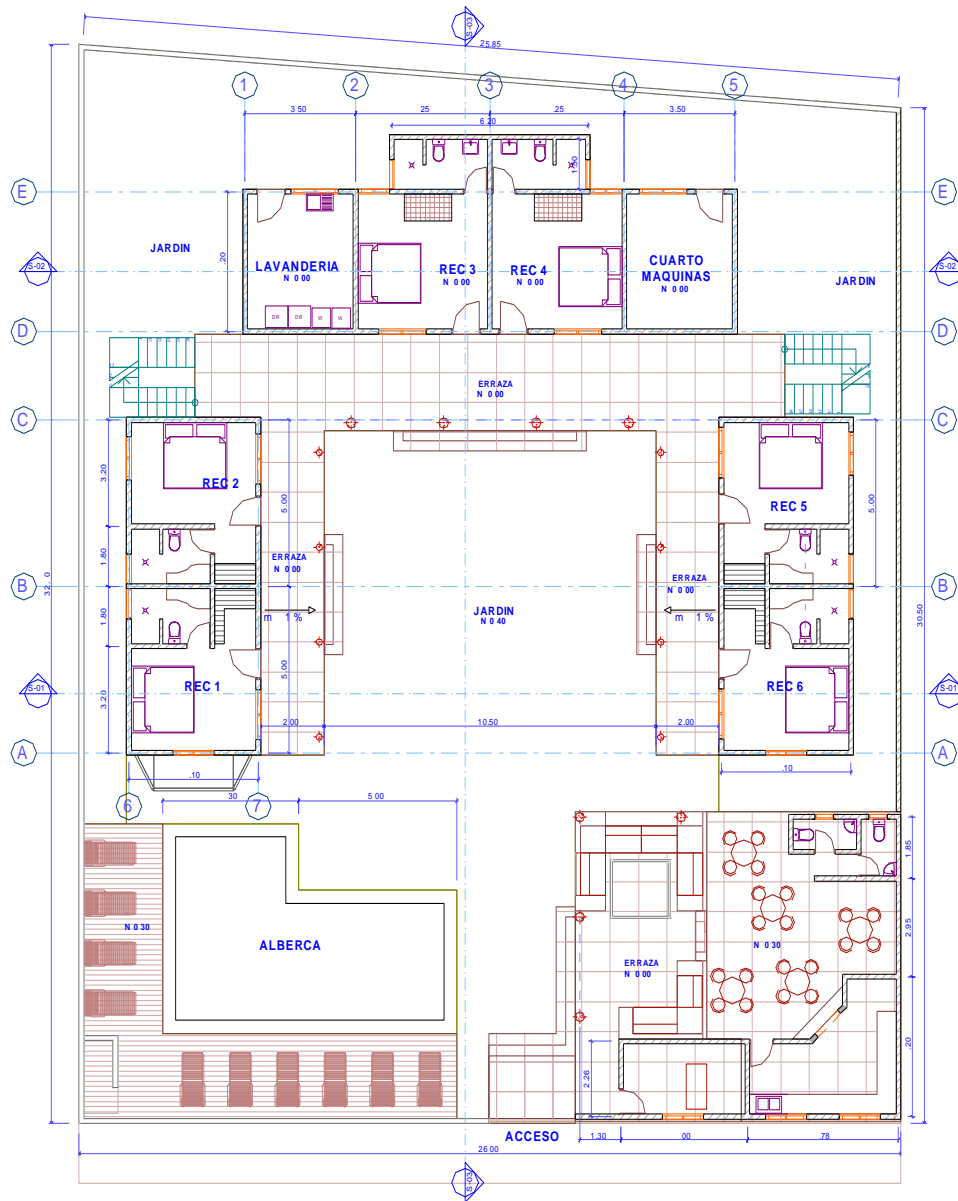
Dimensiones de la planta baja de la casa habitación de verano Oltre Océano.
